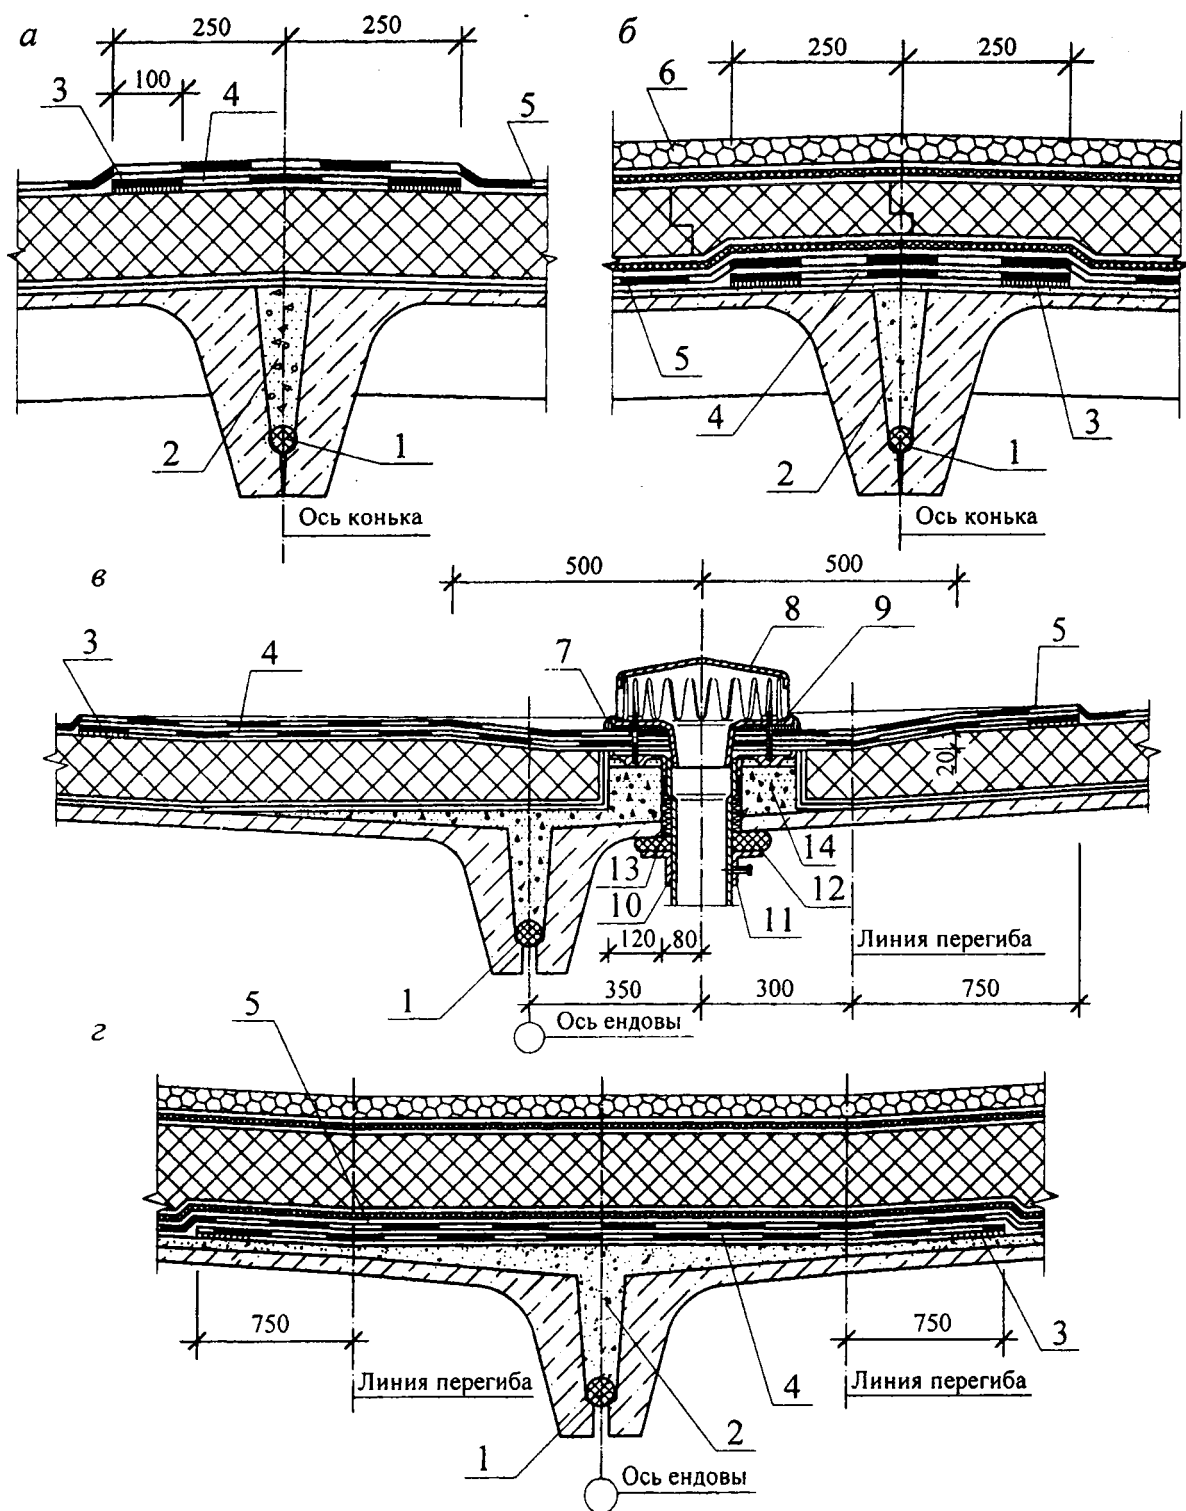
Устройство мембранной кровли по покрытию из железобетонных плит:
